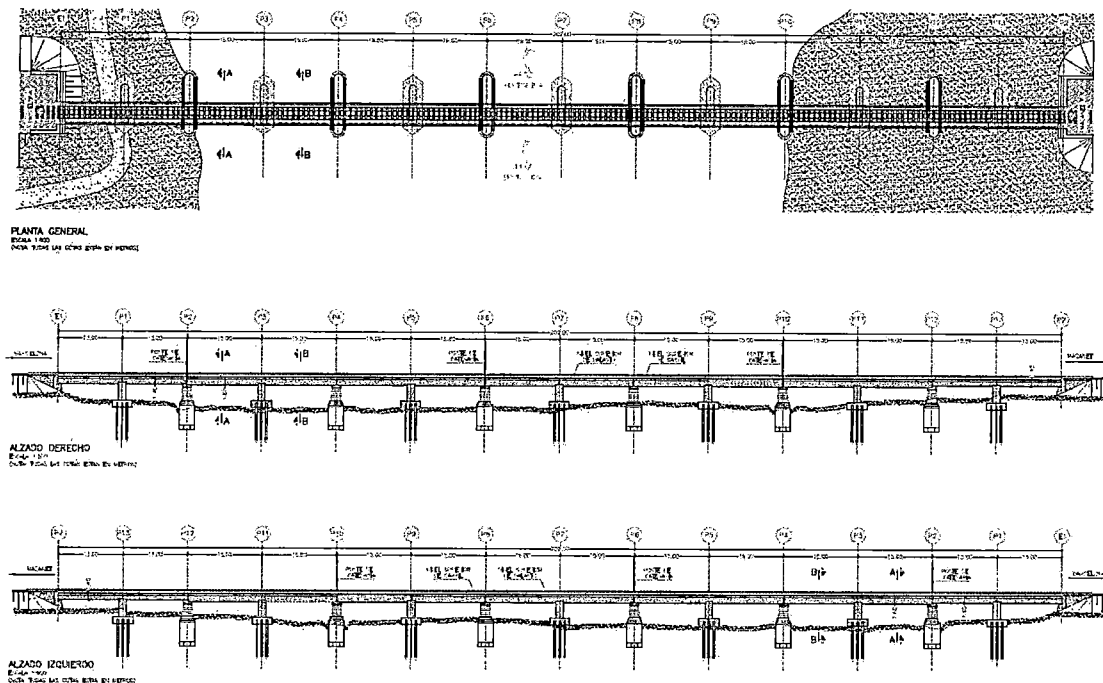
Planta y perfil del puente ferroviario sobre el Río Tordera cuya pila 4 colapsó el pasado 22 de enero.
